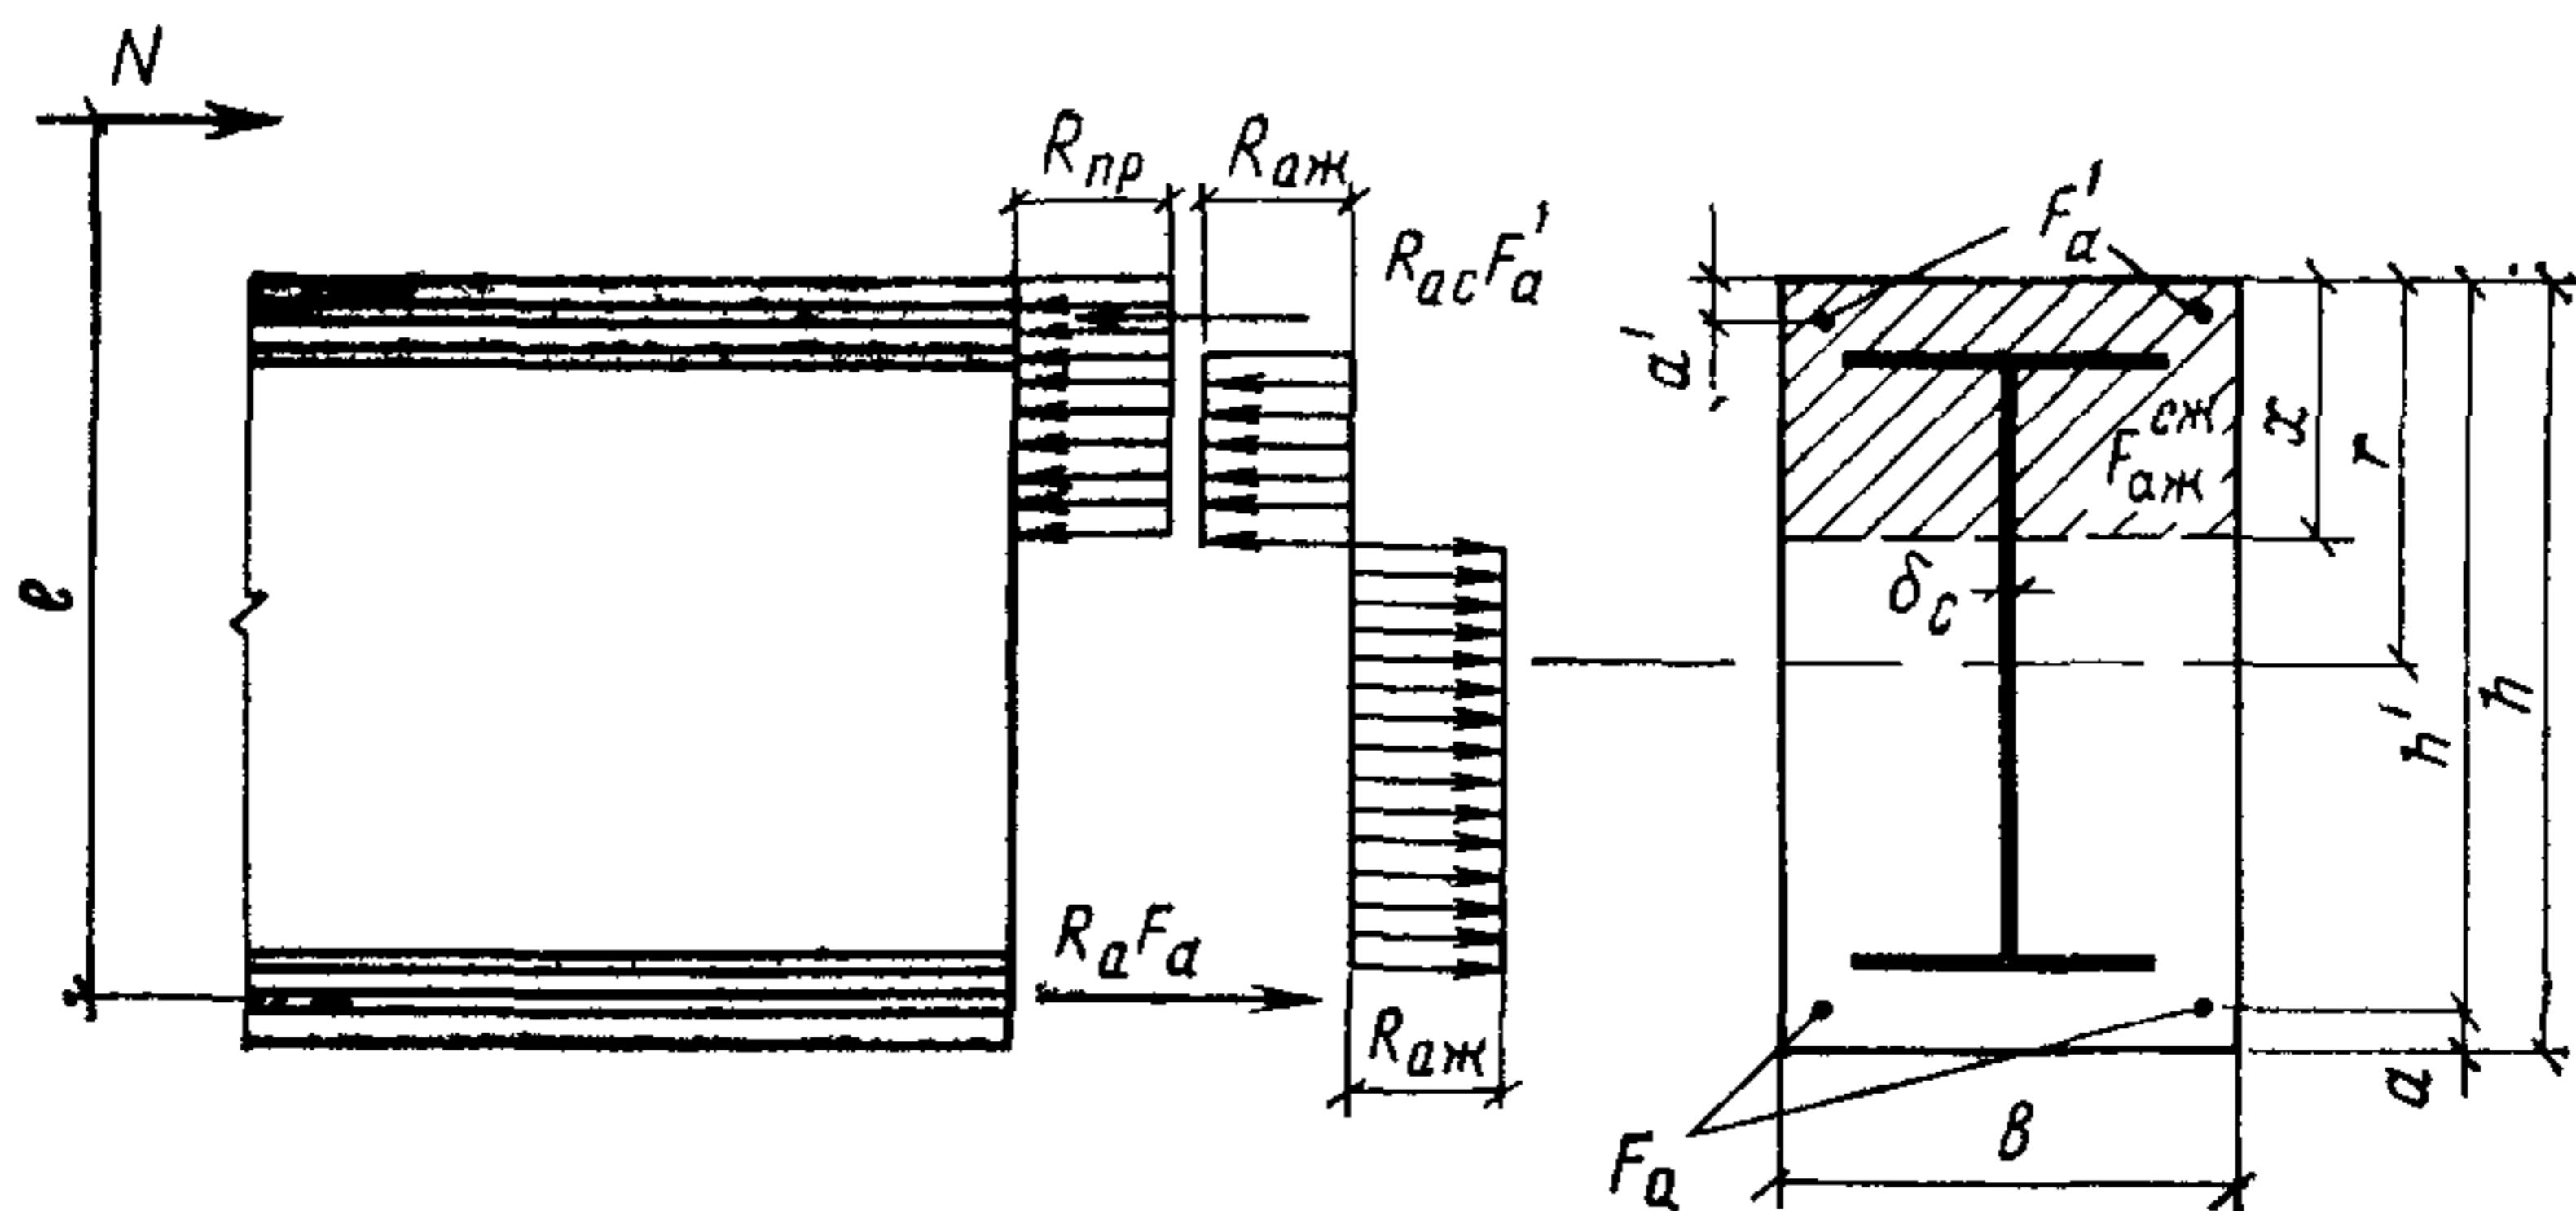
Схема усилий в прямоугольном сечении сжатого элемента с жесткой арматурой в виде симметричного профиля, стенка которого расположена параллельно плоскости действия изгибающего момента
